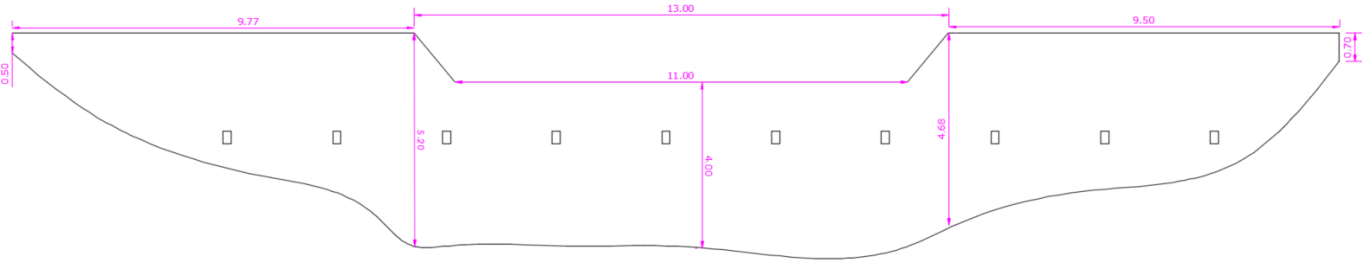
Schéma caractéristique - Élévation aval de l'ouvrage BA010
